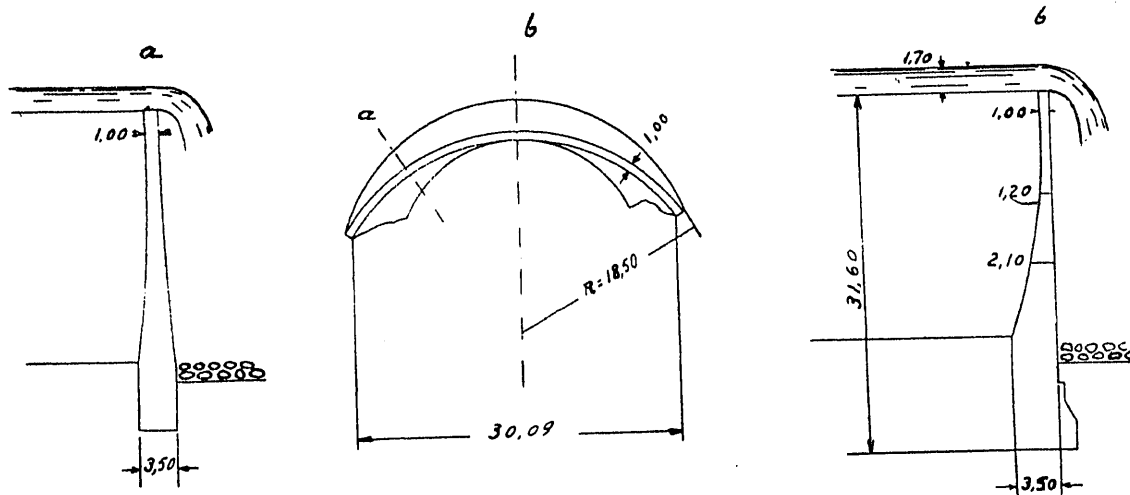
ª Planta y secciones de la presa de Amsteg.
